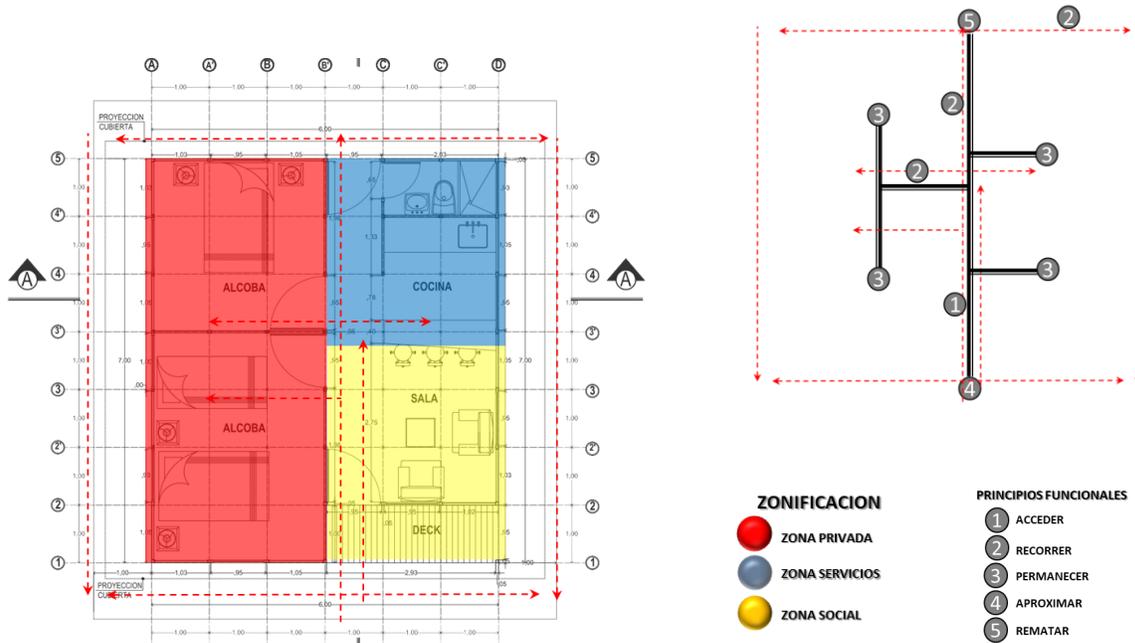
Planta Distribución Vivienda Rural 42m<sup>2</sup>, Fuente: Elaboración propia.
